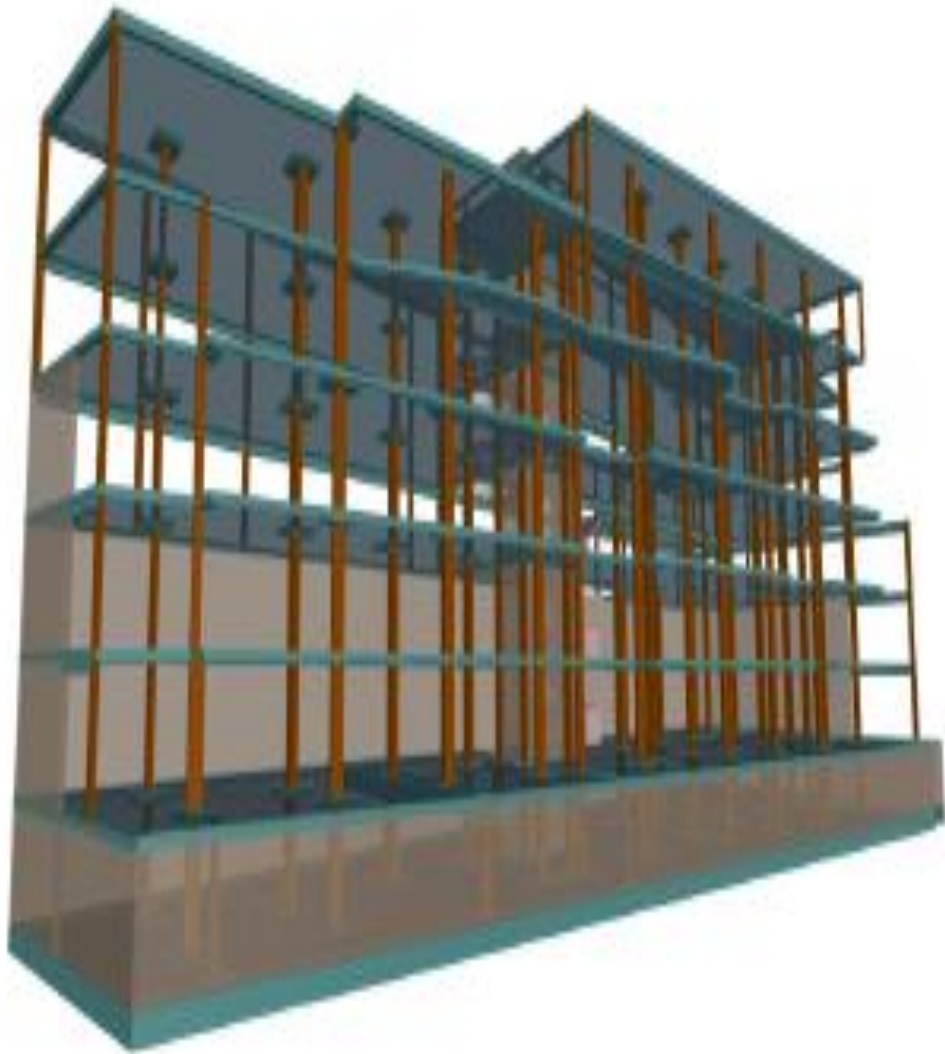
Modelo icónico estrutural do Edifício em 3D (fonte - arquivos do pessoal da fiscalização)
